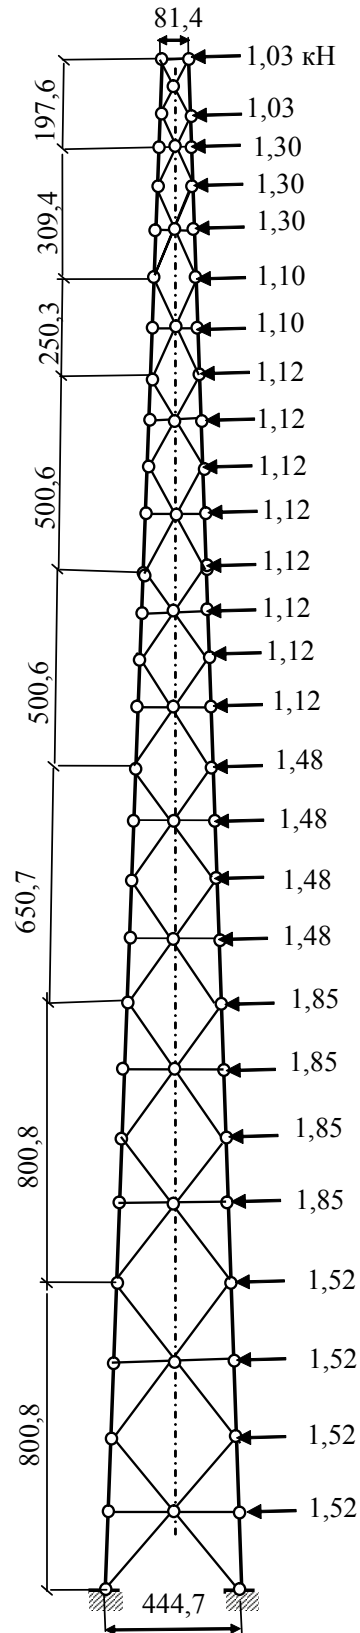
Расчетная схема фермовой конструкции бакенного типа на ветровую нагрузку.
